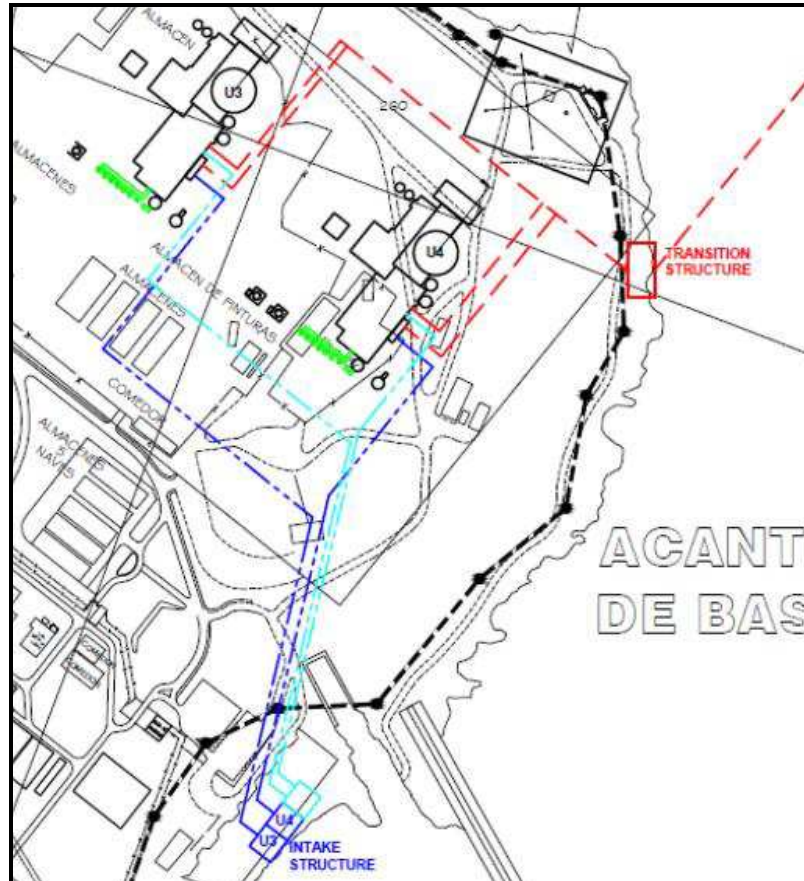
Vista de Planta Sistema Abierto de un solo paso
